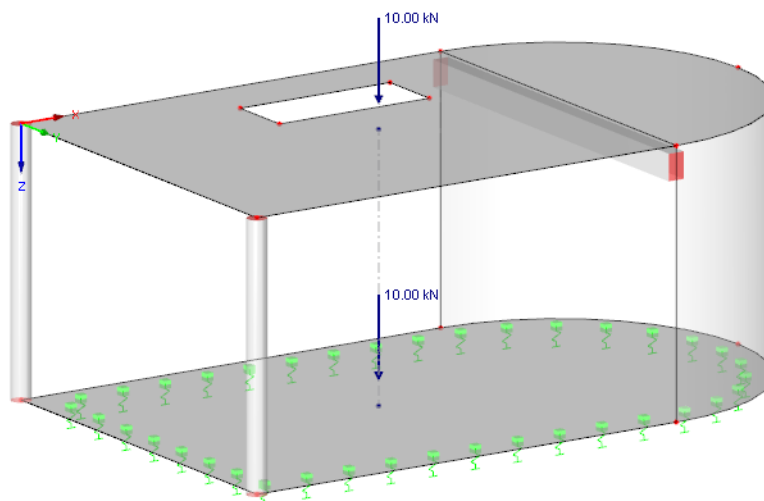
La charge concentrée libre agissant sur le plafond : plan XY de projection de charge avec influence sur la dalle de plafond et sur la dalle de plancher
